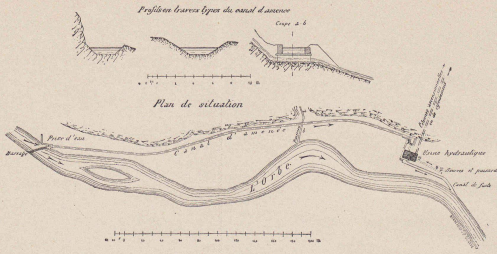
Plan général de l'établissement hydraulique sur l'Orbe.
